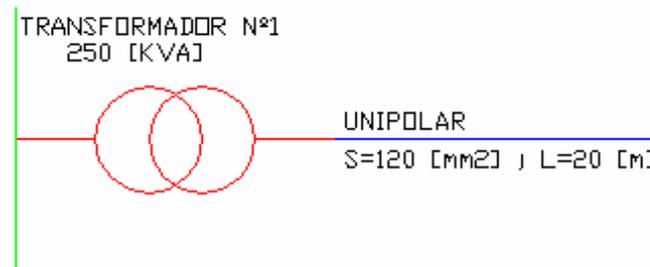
Datos del cable del transformador sobre la pantalla de AutoCAD.
